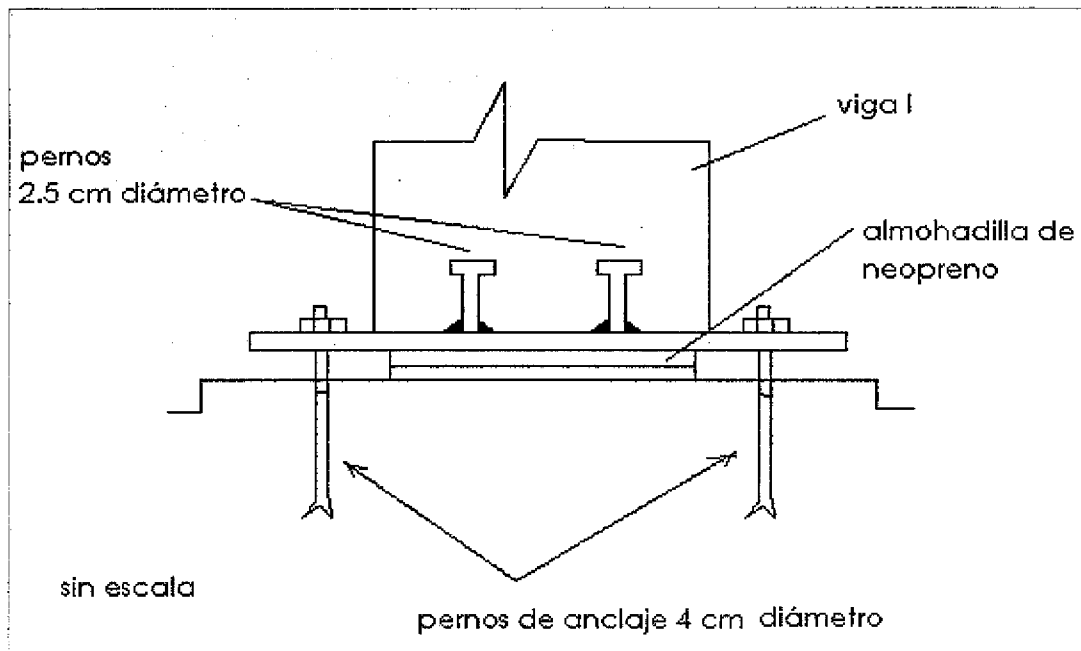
Detalle de anclaje para viga tipo I especificado en los planos.
